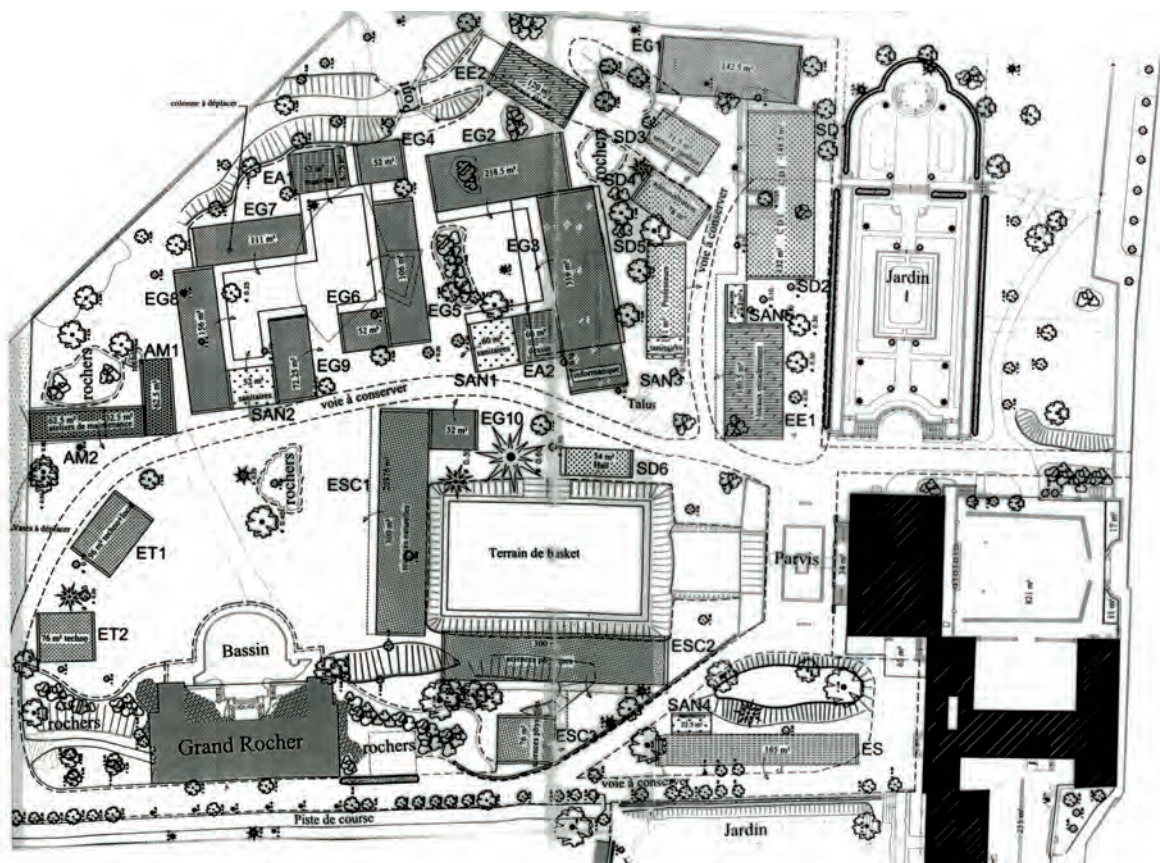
Plan topographique du jardin - Implantation des bungalows de la cité scolaire provisoire (vers 2005)
